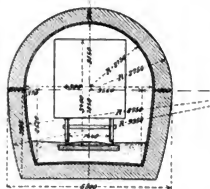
Tunnelquerschnitt für eingleisige gerade Strecken, 1:150.
